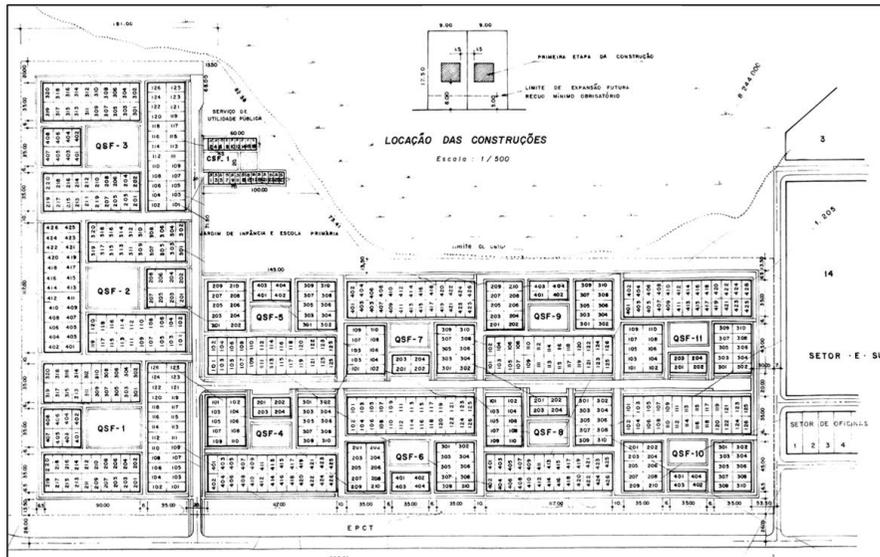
Planta do Setor F Sul de Taguatinga (planta de 1965). Fonte Sisduc/Seduh (GDF).
